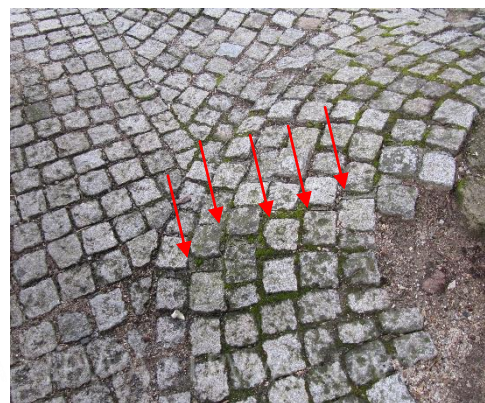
Fissuras no pavimento (lado da tração).
